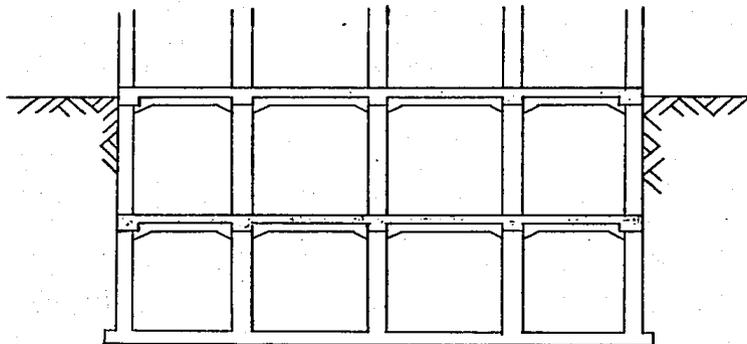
CAJON PROFUNDO PARA EDIFICIOS.
